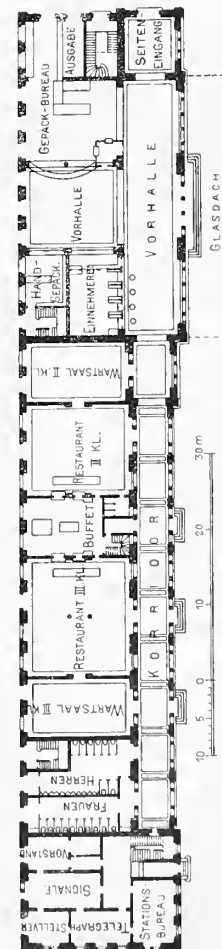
Grundriss vom Erdgeschoss des neuen Aufnahme- und Verwaltungsgebäudes im Bahnhof St. Gallen. — Masstab 1:1000.
